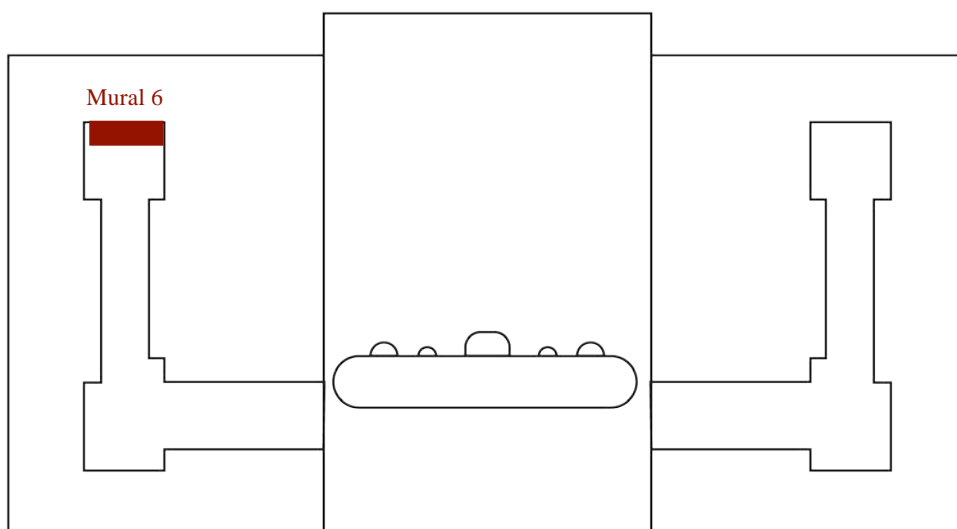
Mural 6: Dignatario. Planta del adoratorio.
